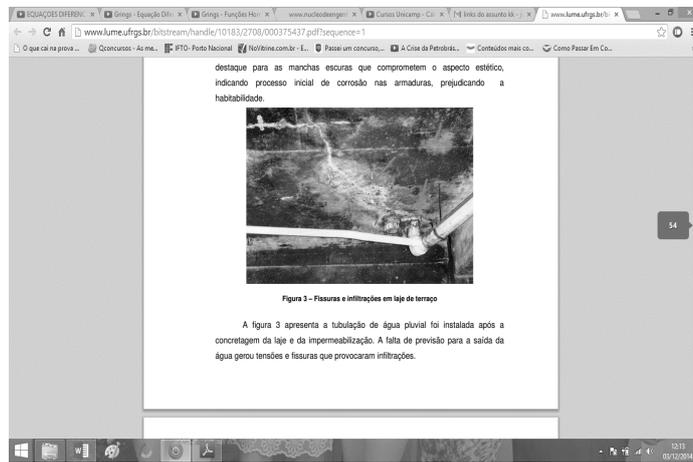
Fissuras e infiltrações em laje de terraço
